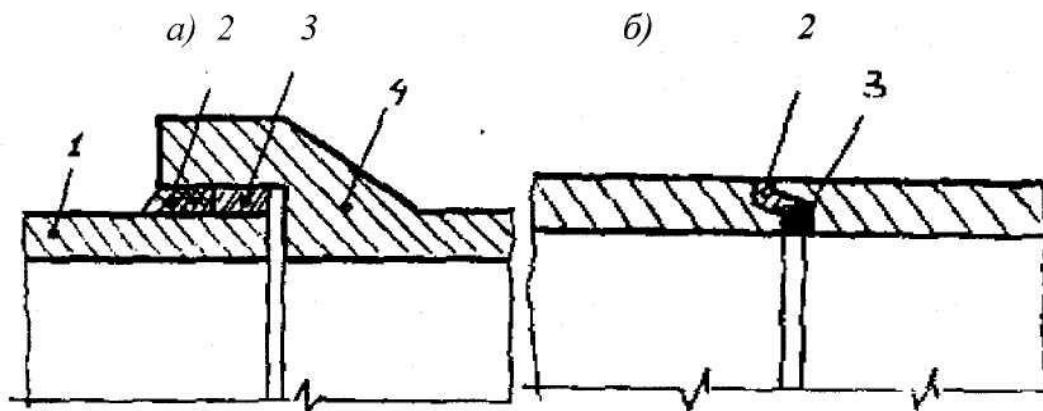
Схеми розтрубного (а) та фальцевого стиків (б) бетонних труб
